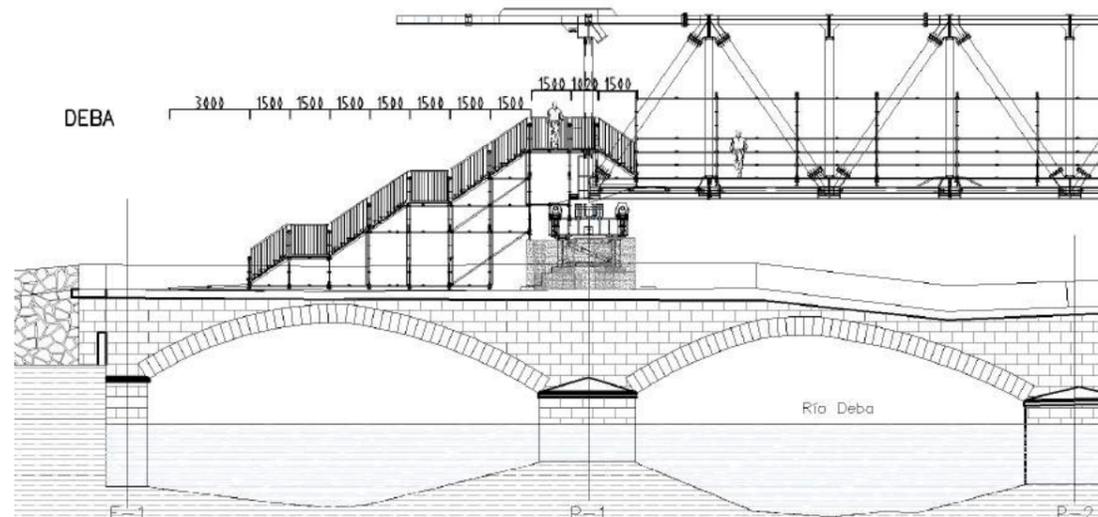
Alzado de las escaleras de acceso a la pasarela provisional desde el lado de Deba. En cuanto al acceso desde el lado de Mutriku, éste presenta un desarrollo en planta en forma de L, con el fin de invadir el menor espacio posible de vial inferior, tal y como se puede observar en la imagen inferior.
